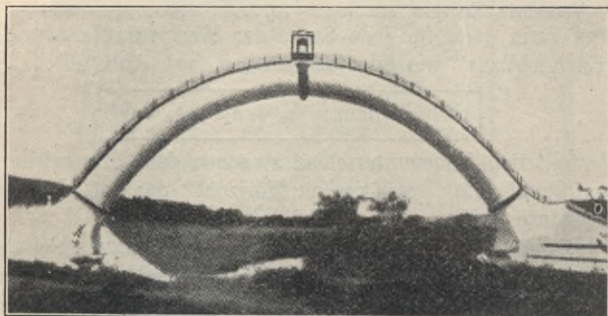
Eisenbetonrohrbrücke (Bauingenieur).
